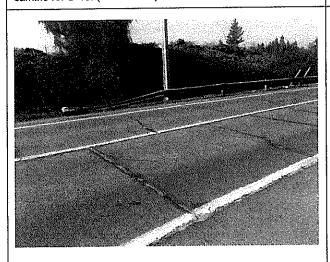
Calzada de asfalto con grietas, kilómetro 5,4, camino rol G-40. (21-08-2013)
